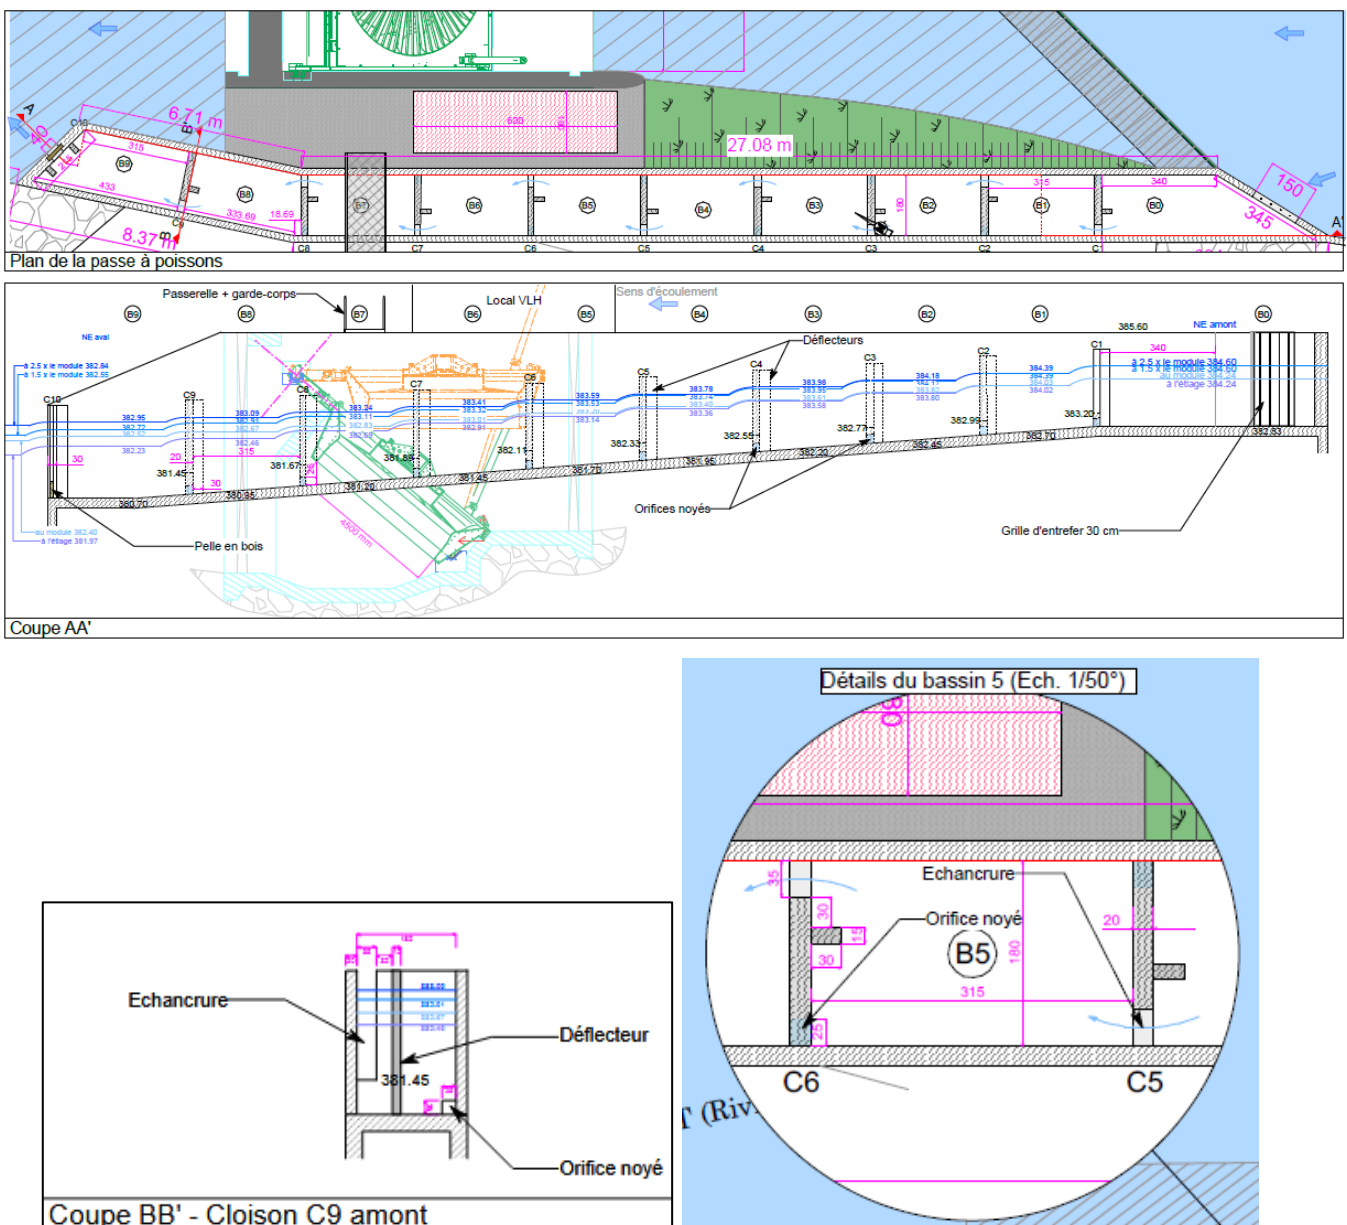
Plans et coupes de la passe à poissons projetée sur le site futur
